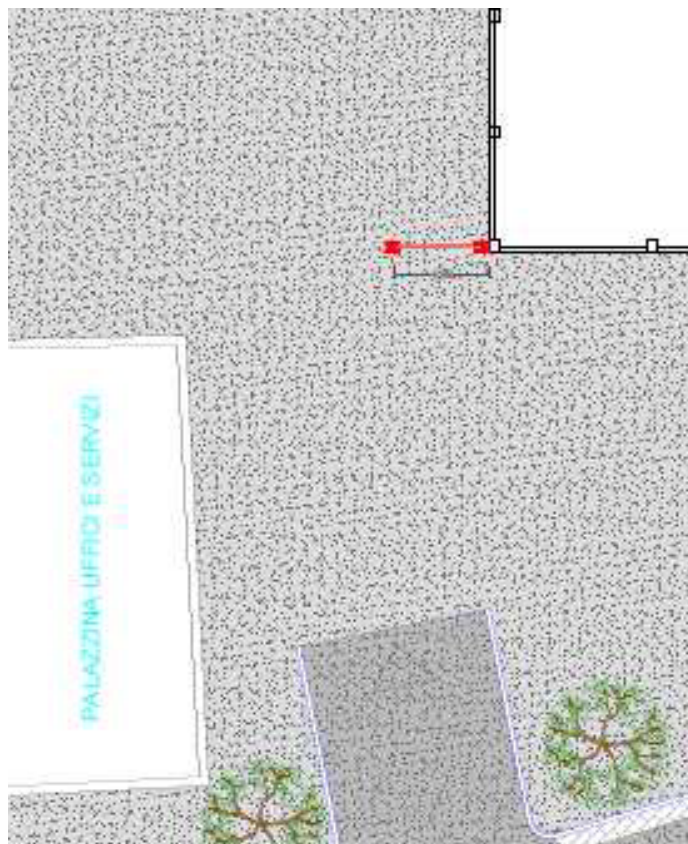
Individuazione planimetrica barriera di contenimento acustico B
